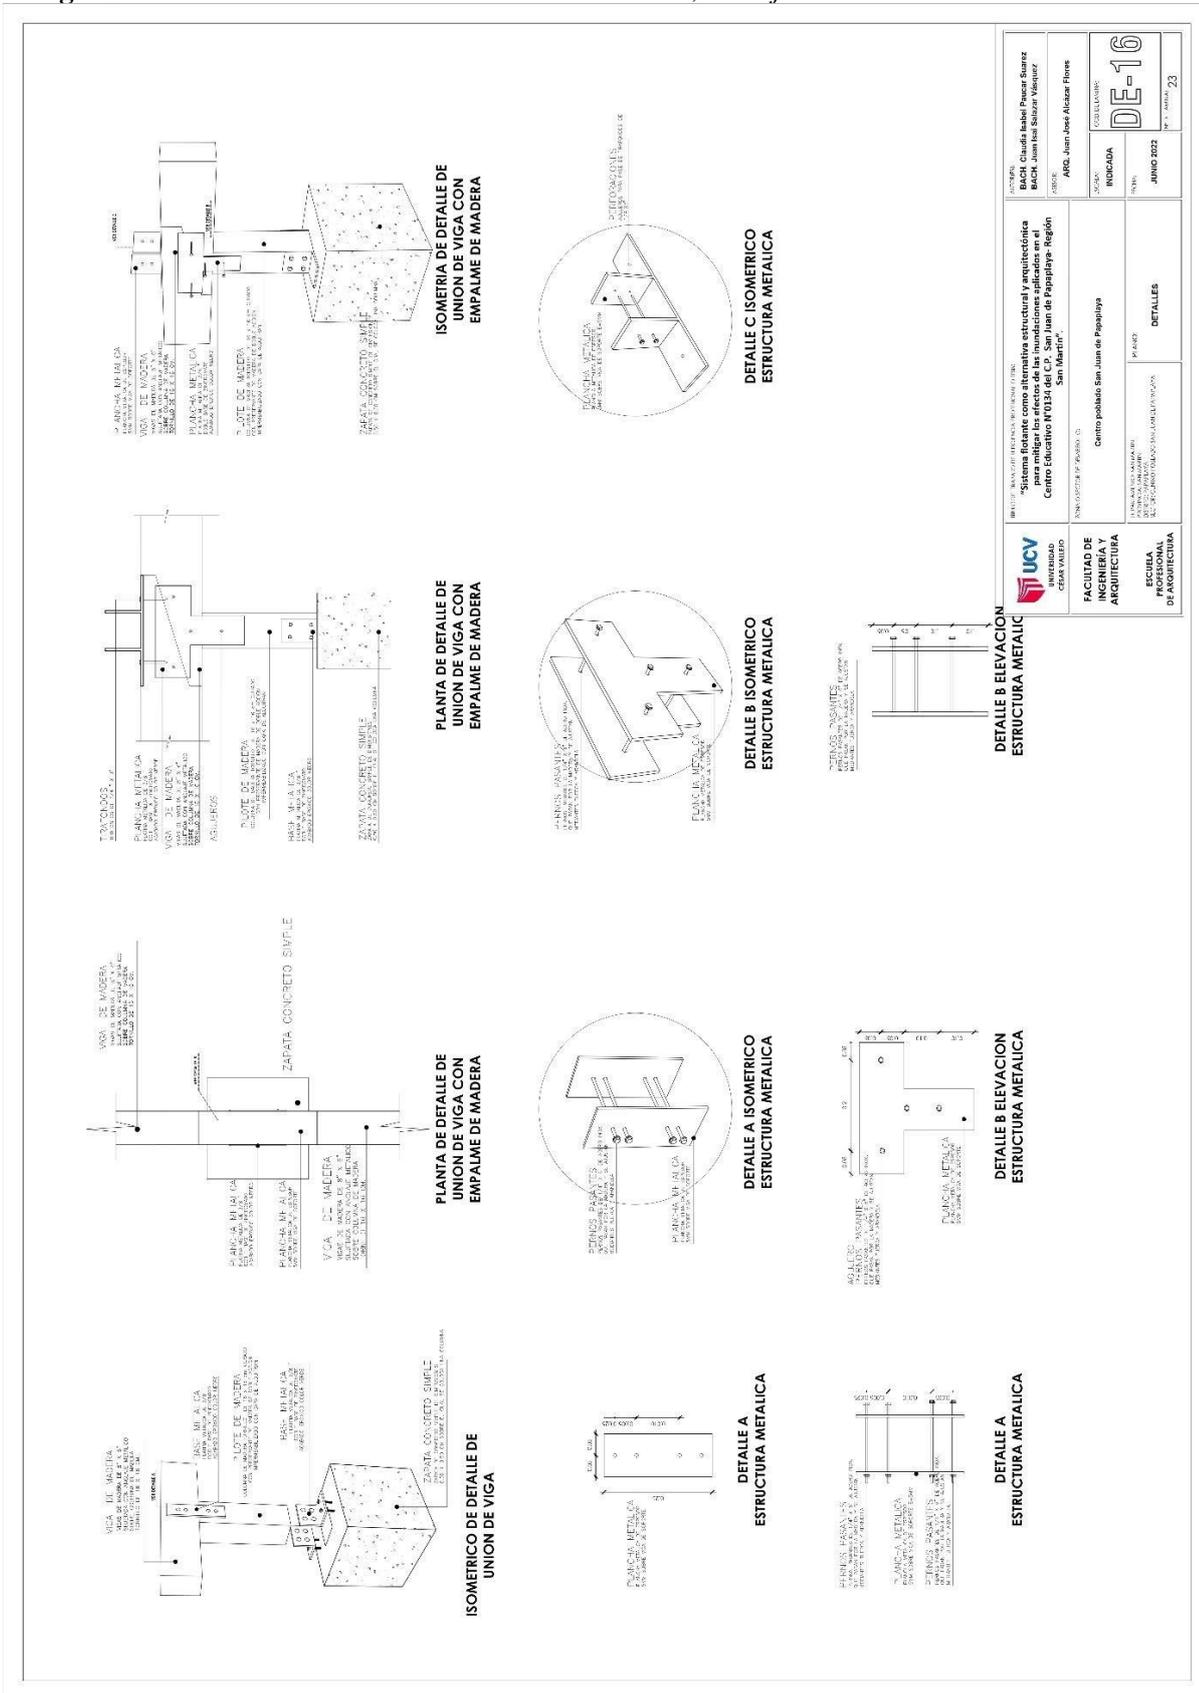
Plano de detalles constructivos: encuentros, anclajes
